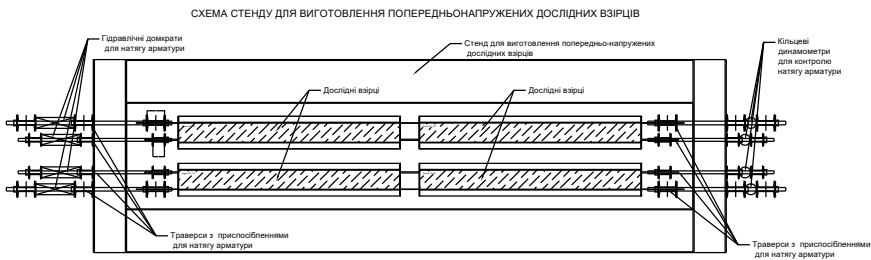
Схема стенду для виготовлення попередньо напружених сталобетонних балок, армованих пакетом арматур
